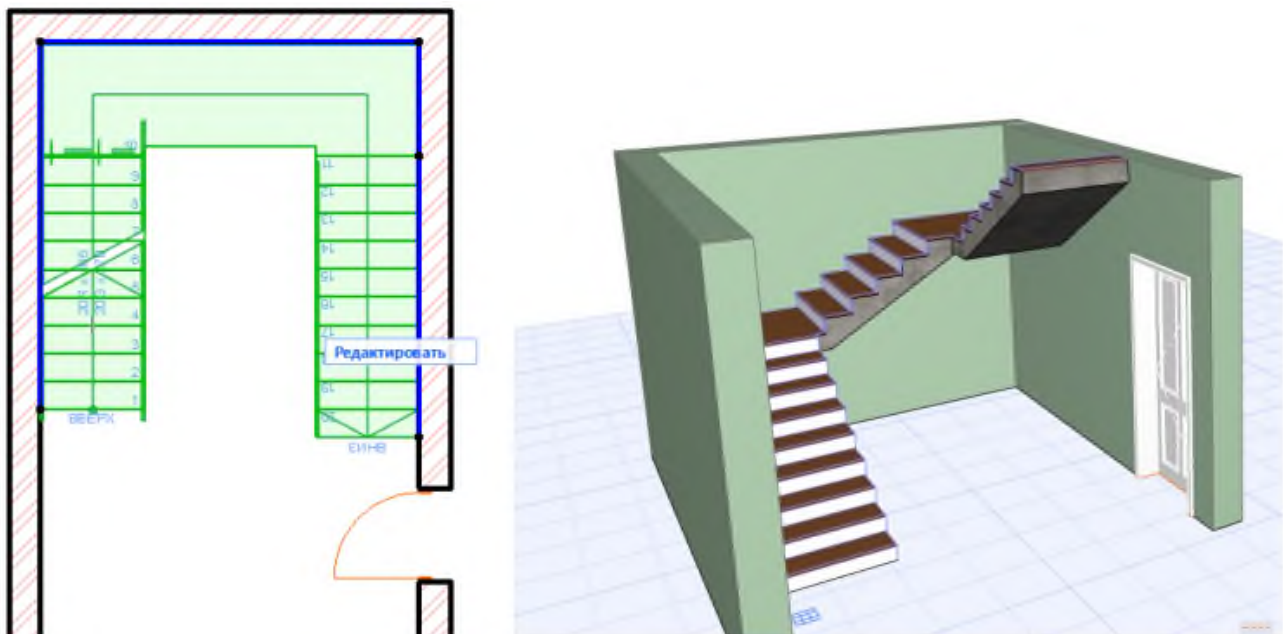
Побудовані сходи на плані поверху та в 3D-вікні
